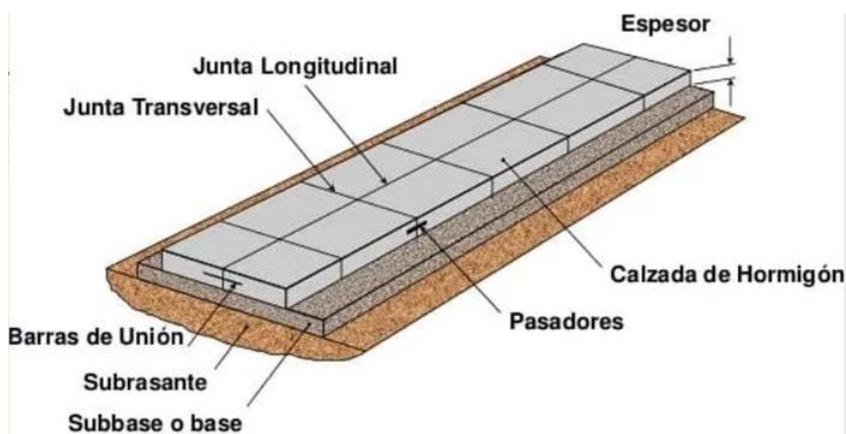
A. – Esquema del pavimento rígido a plantear en el presente proyecto
